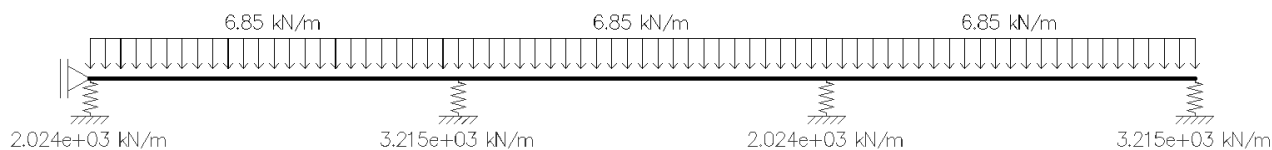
36 – Esquema estrutural do pavimento em análise.
